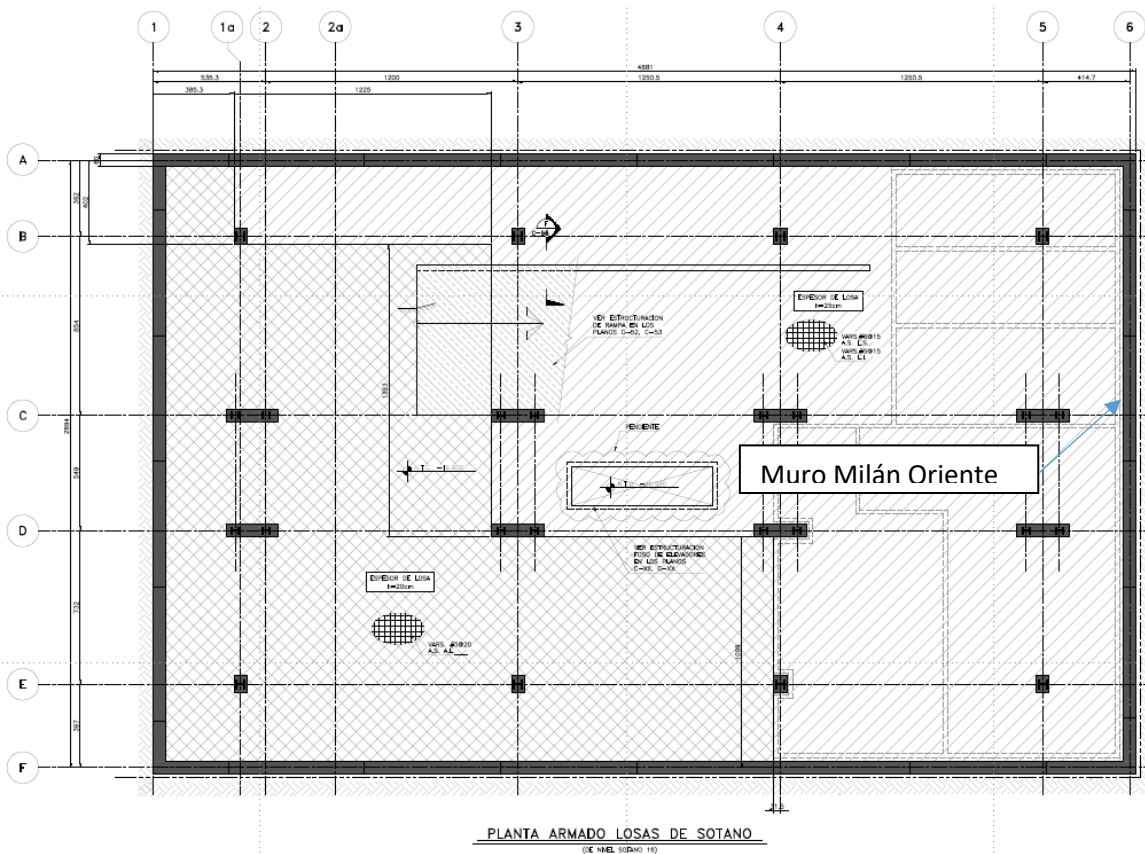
Planta armado losas de sótano proyecto Insurgentes 700 (CIMESA, 2015).
